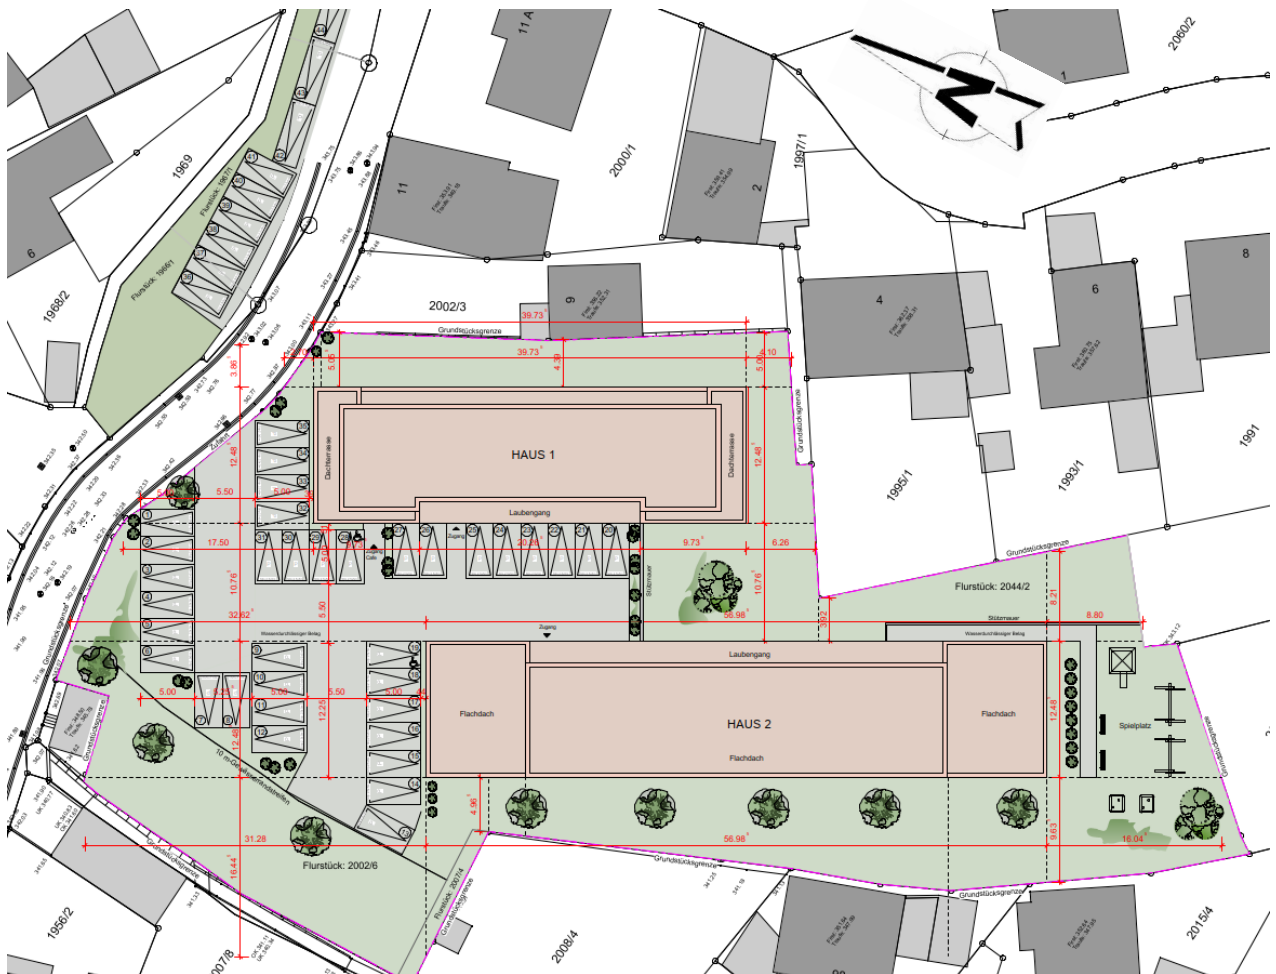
Lageplan des Bauvorhabens [2]
